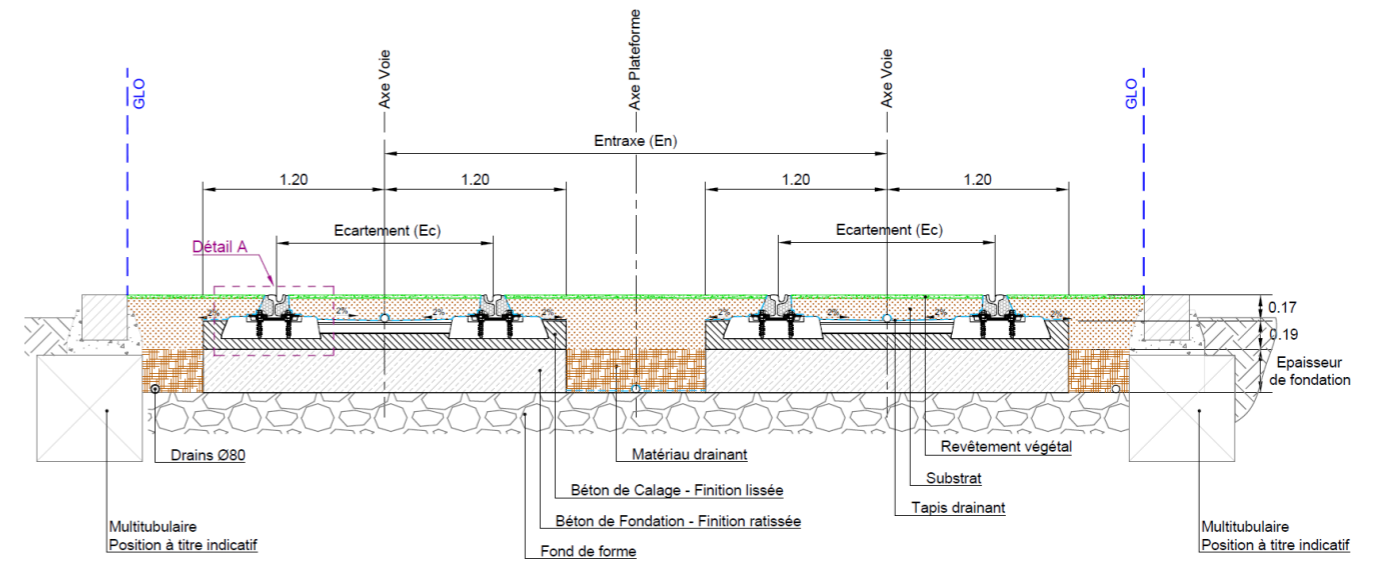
coupe type d'une plateforme - Voie béton traverses – Revêtement végétal
